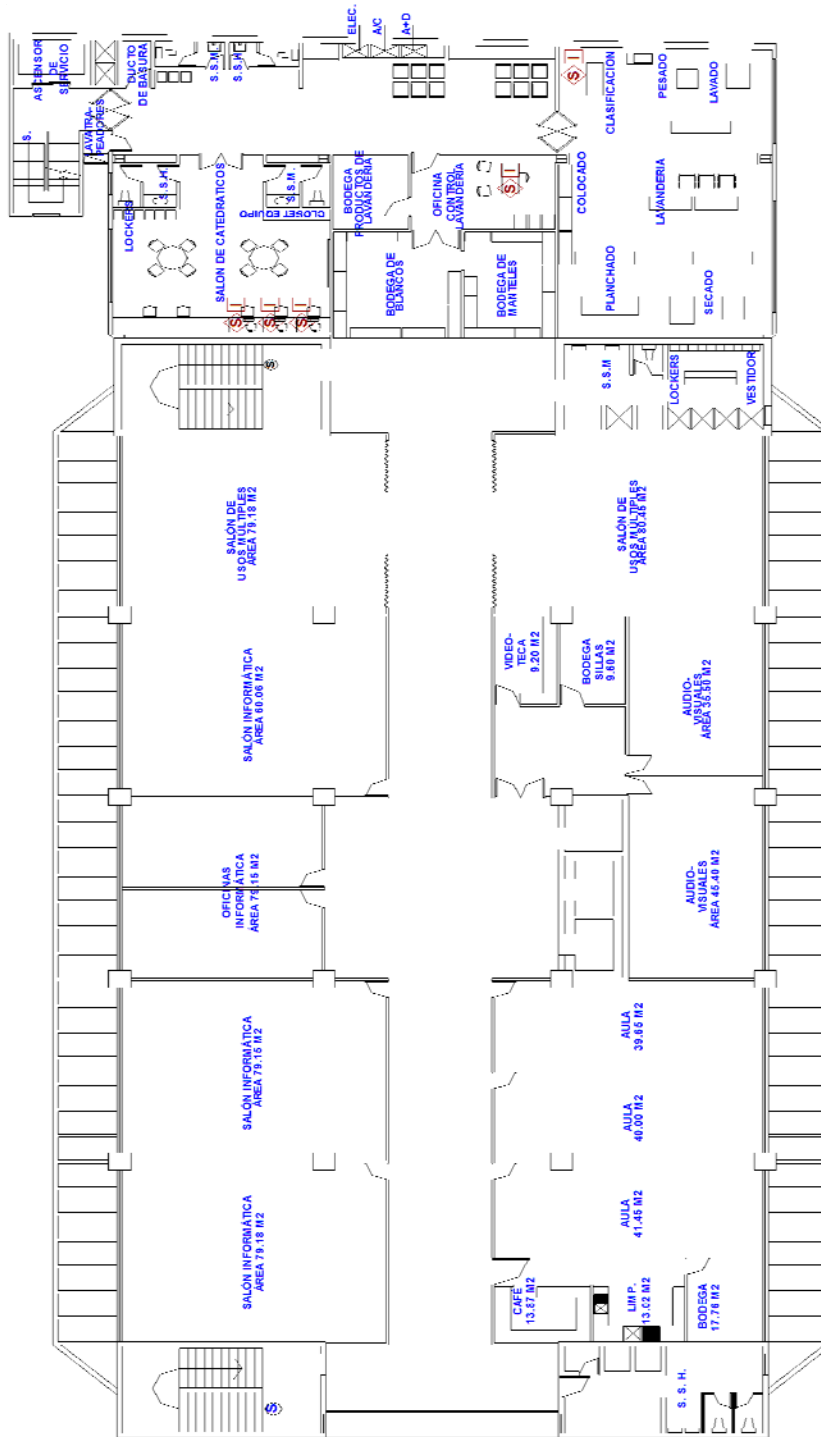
Plano planta baja. Servicio al público Restaurante Escuela
